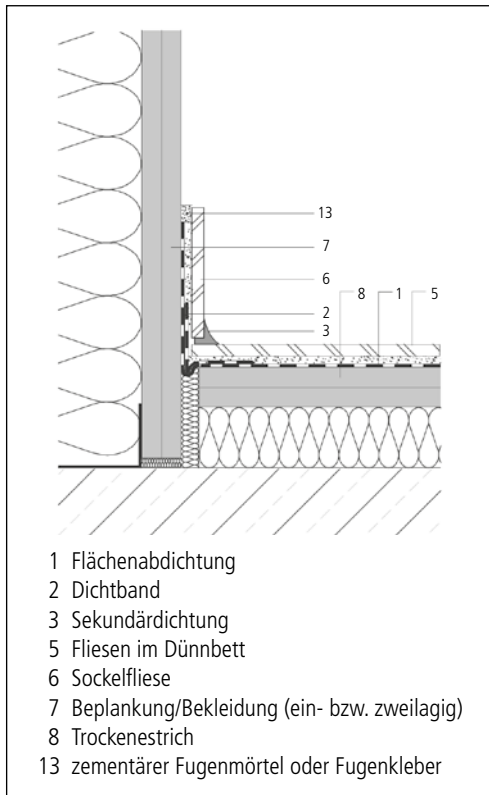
■ Trockenestrich mit Verbundabdichtung
